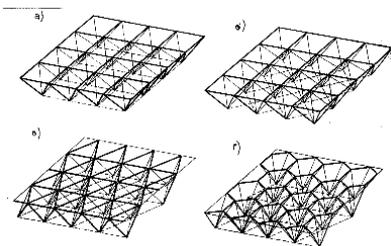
Схема покрытий из вертикальных перекрестных ферм: а, б – при расположении ферм в двух направлениях; в, г – при расположении ферм в трех направлениях
